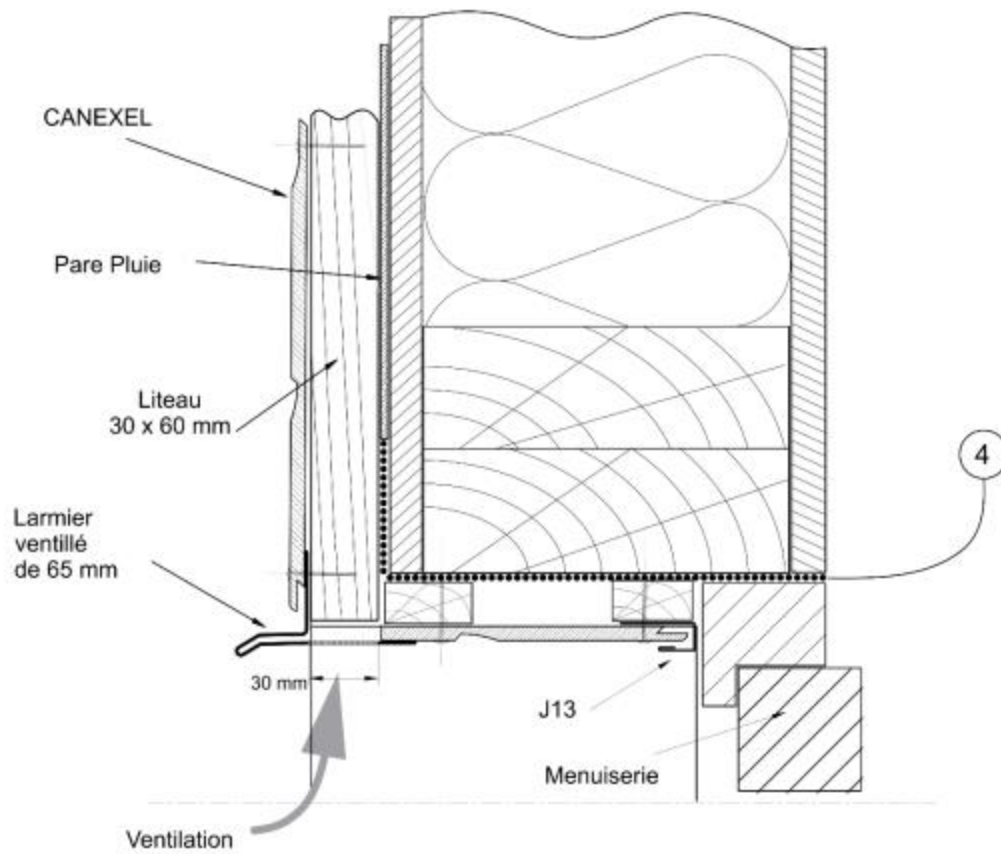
Coupe sur menuiserie avec tableaux sur maçonnerie
